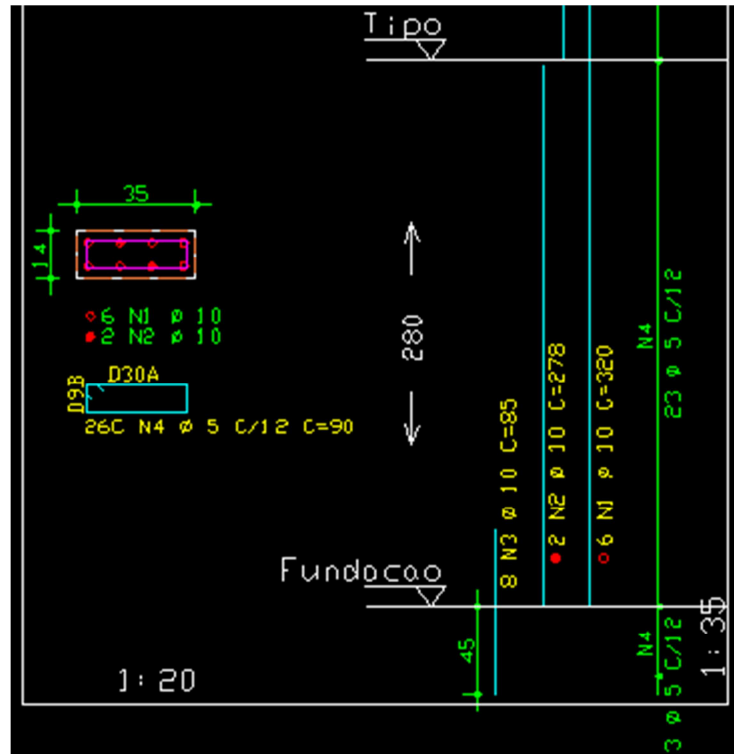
Detalhamento das armaduras de aço do Pilar 11 após da aplicação do SISE.
